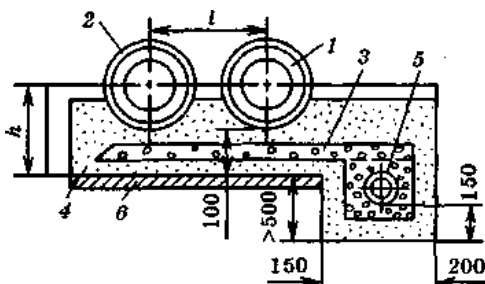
Общий вид двухтрубного бесканального теплопровода в монолитных оболочках: 1 – подающий теплопровод; 2 – обратный теплопровод; 3 – гравийный фильтр; 4 – песчаный фильтр; 5 – дренажная труба; 6 – бетонное основание (при слабых грунтах)
